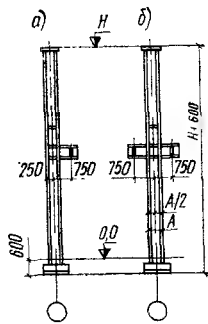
Колонны из одного двутавра для крановых зданий без проходов вдоль подкрановых путей
